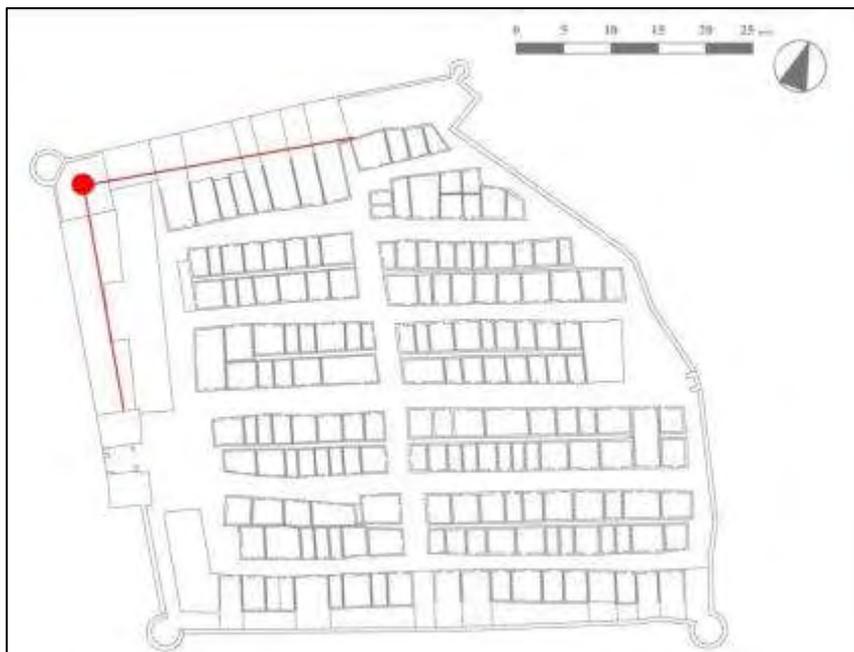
Ricetto di Candelo, planimetria attuale; in rosso la localizzazione della “Torre di Gogna” e l’ipotetico andamento della più antica cinta muraria.
